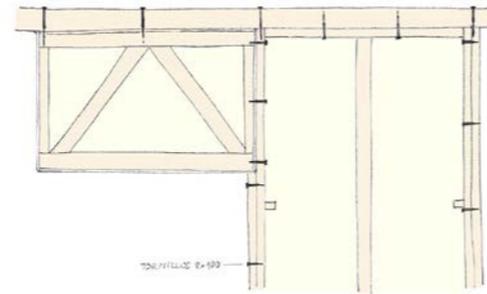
Detalle del encuentro entre la pieza dintel con el panel estándar.
